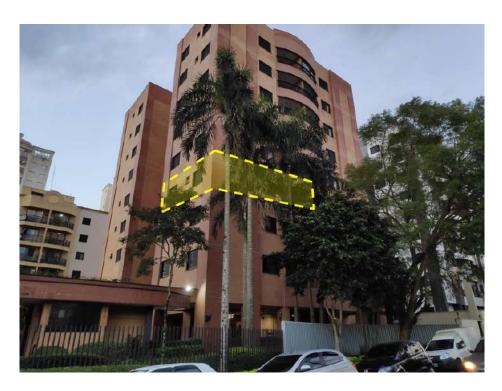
Prumada do Apartamento (Obejeto de exame)
